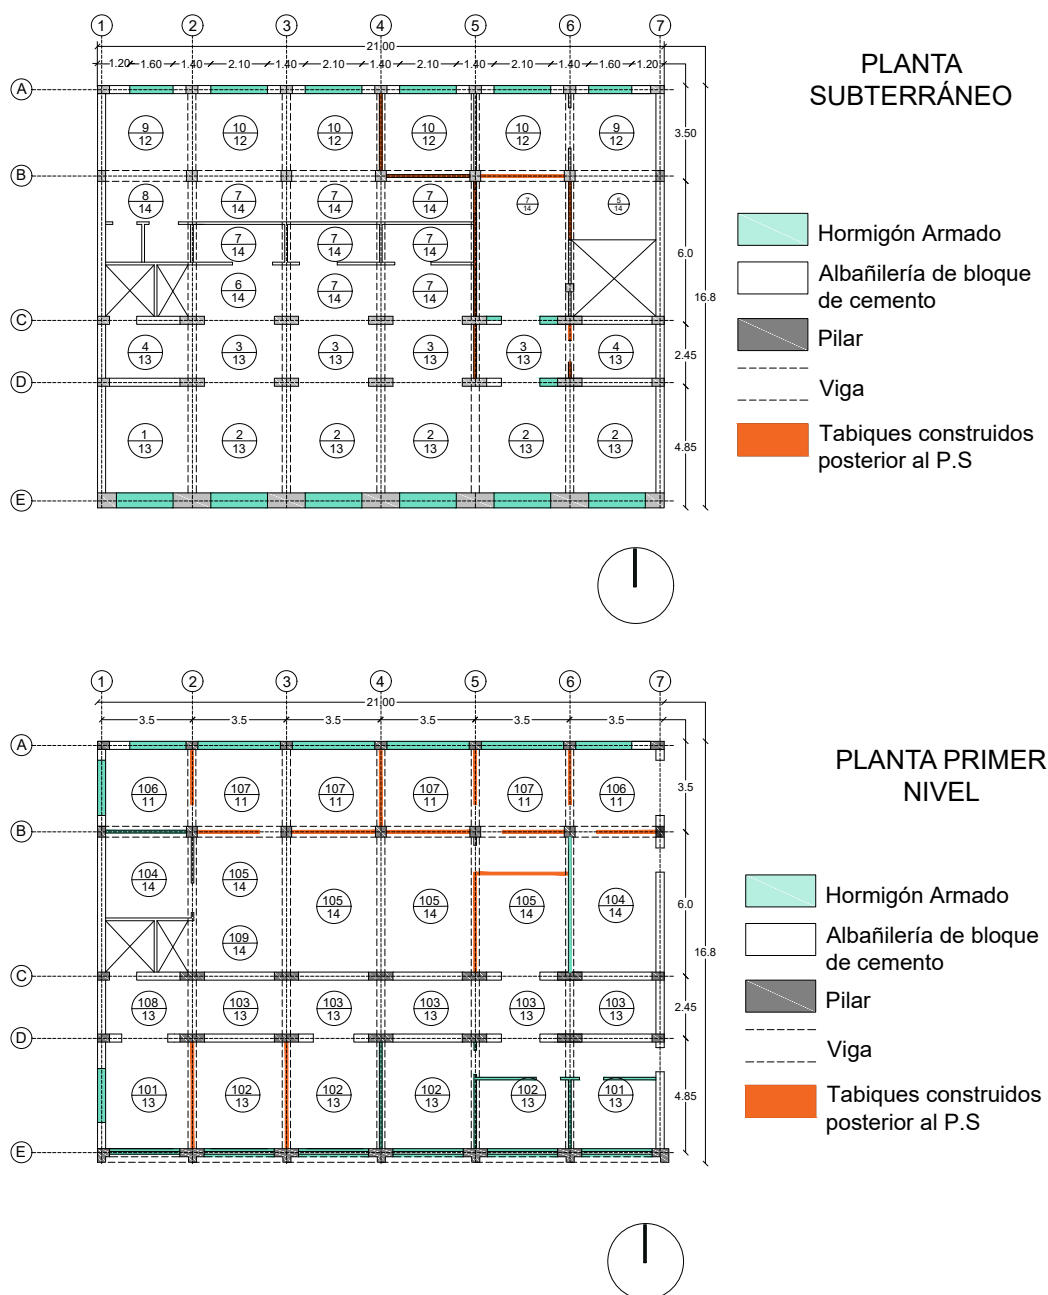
Plantas de Estructura Subterráneo y Primer Nivel, Escuela de Minas. Fuente Elaboración propia.
